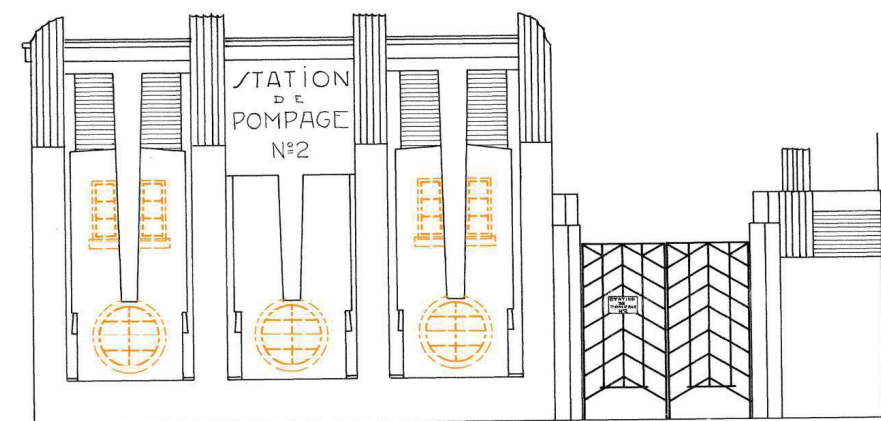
Élévation de la façade Nord du massif de vannage - ech. 1/100
